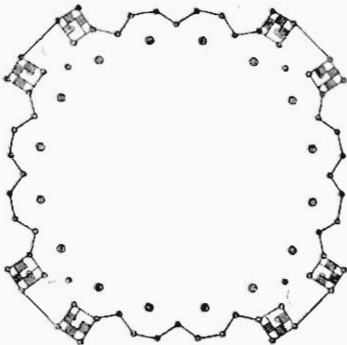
Salle des Fêtes. — Plan à rez-de-chaussée.
